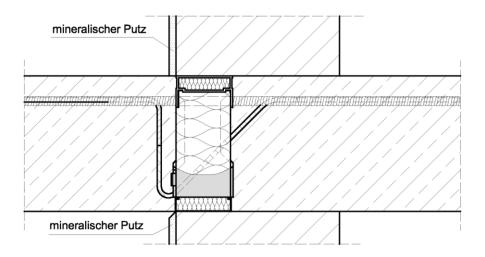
Schöck Isokorb® (REI30) gem. Abschnitt 3.2.2
